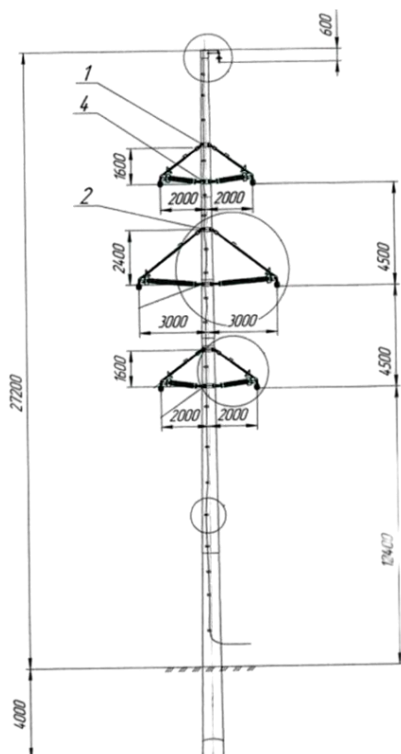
Заводской чертеж композитной промежуточной двухцепной опоры для ВЛ 110 кВ марки ПК110-2
